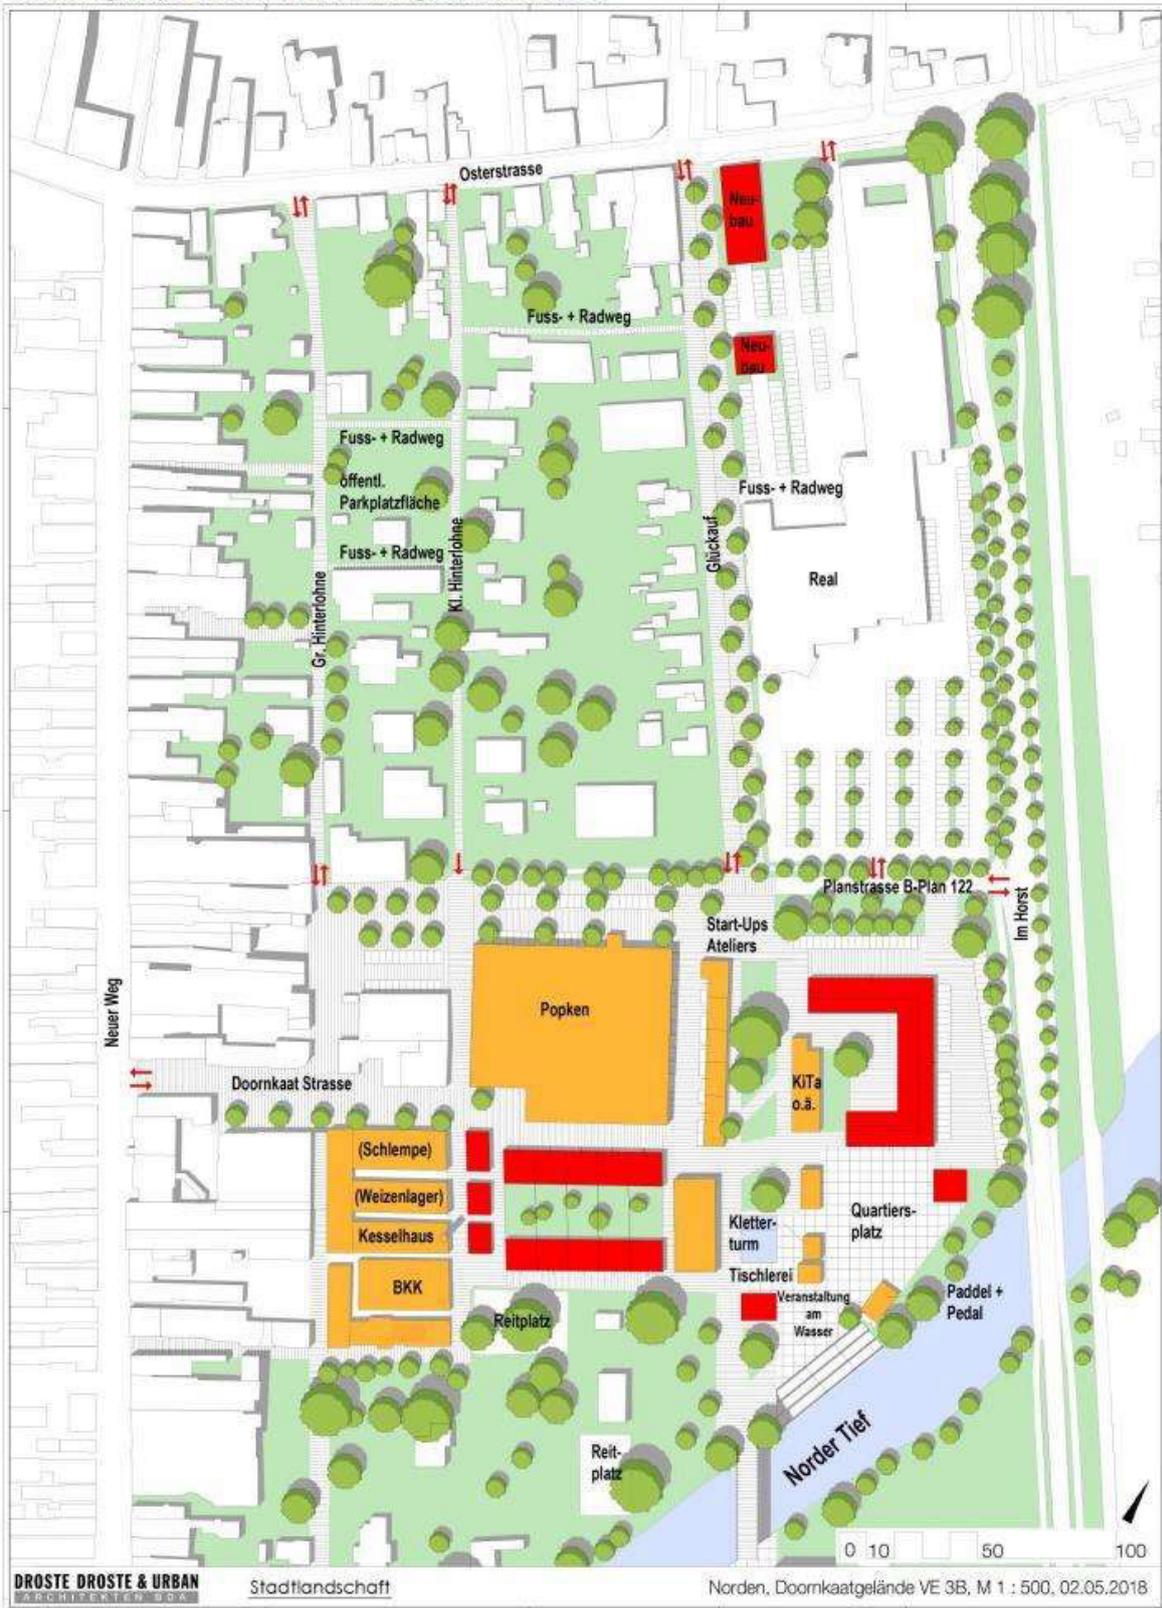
Rahmenplan Doornkaatgelände (Variante B)
